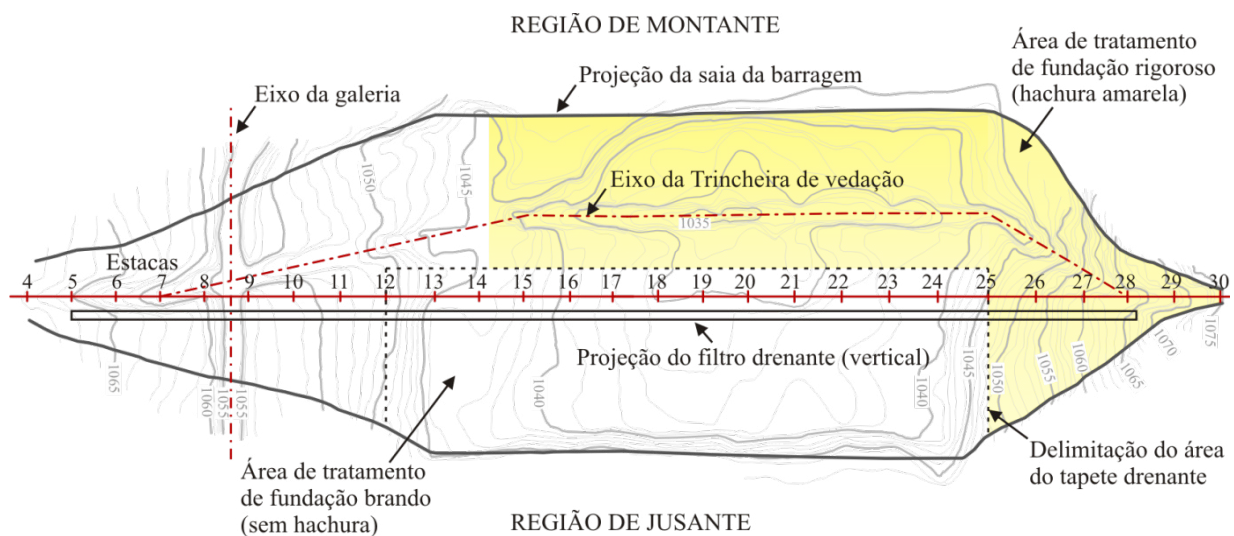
Tratamento de fundação (modificado de Geotécnica, 1971).
